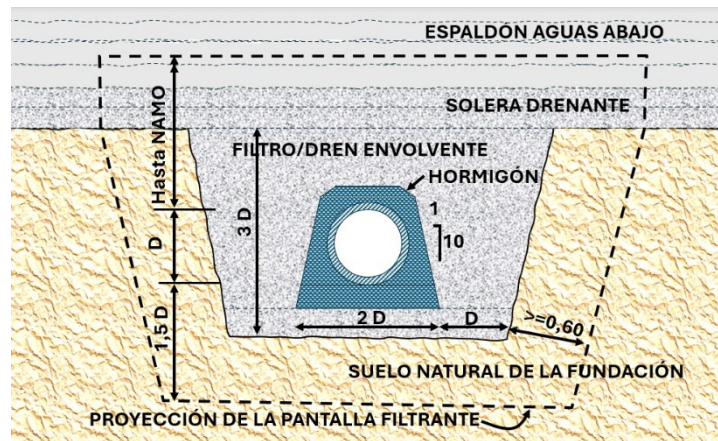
Elementos alrededor de una tubería a través de la presa. Sección bajo el espaldón aguas abajo.
